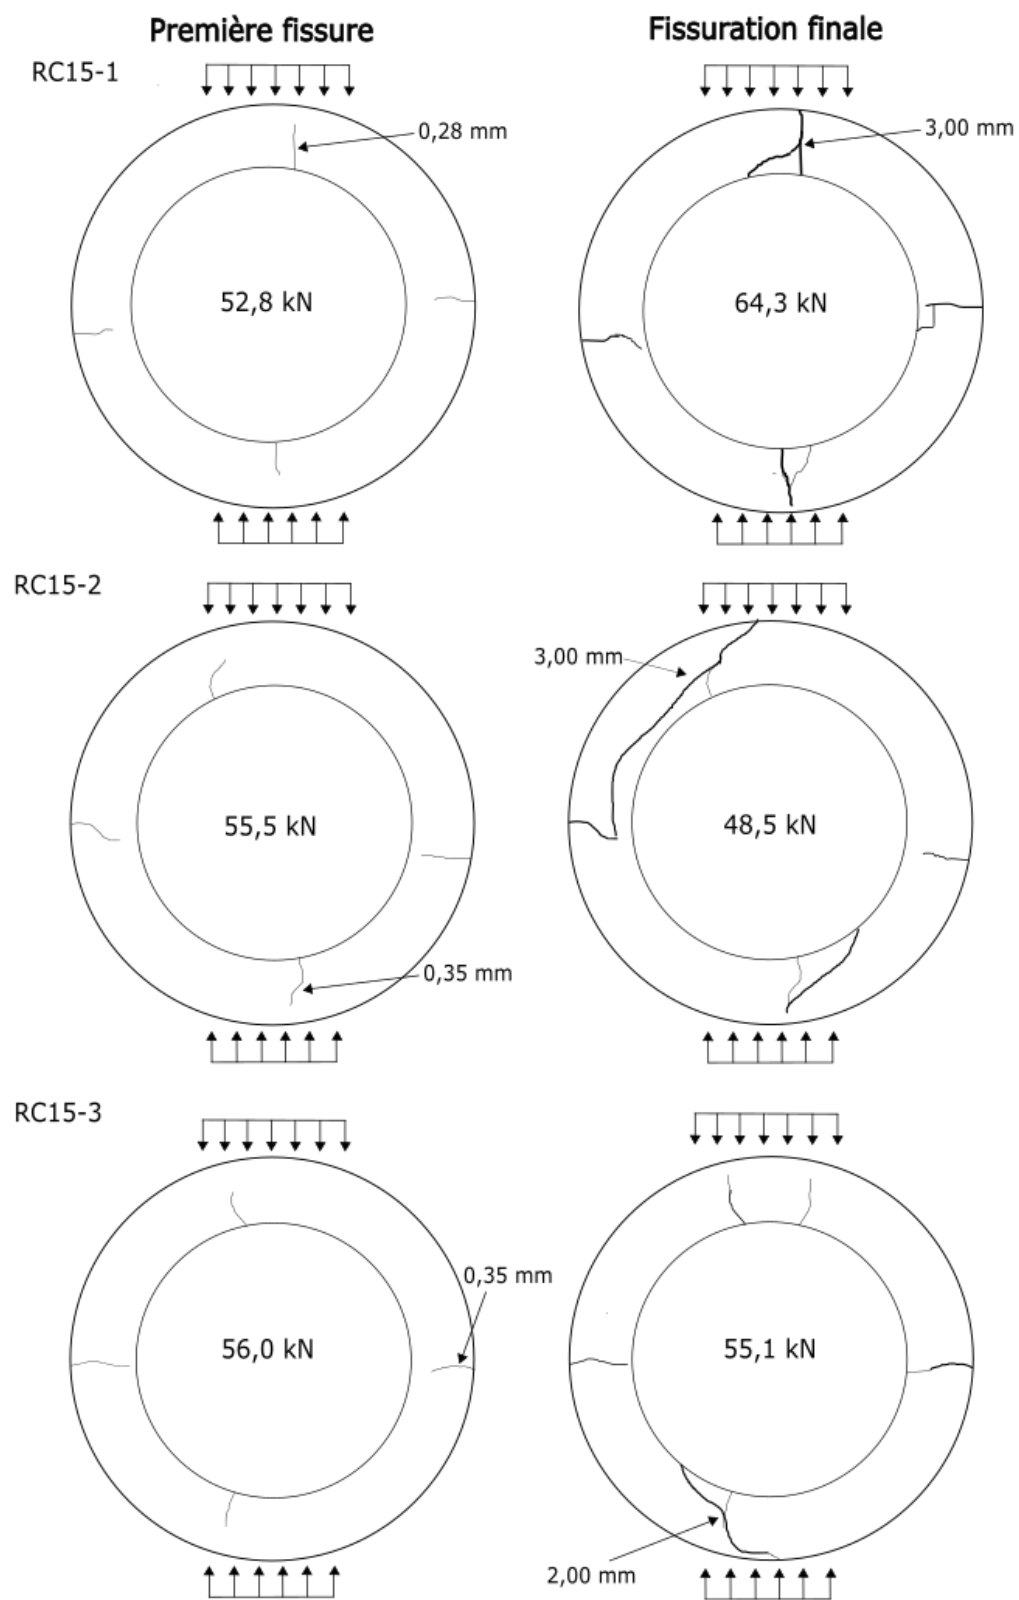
Premières fissures et fissuration finale des sections de tuyaux avec 15% de RB
